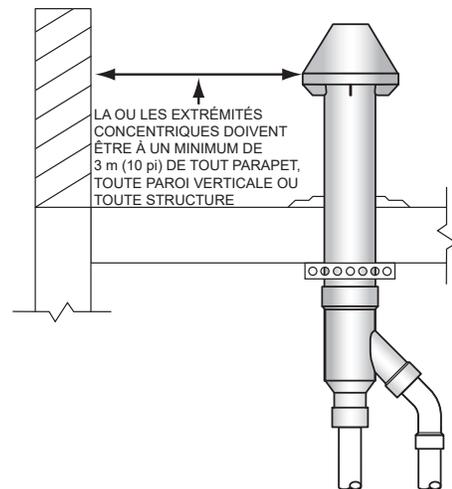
Bouche concentrique sur toit plat - Dégagements par rapport au parapet
